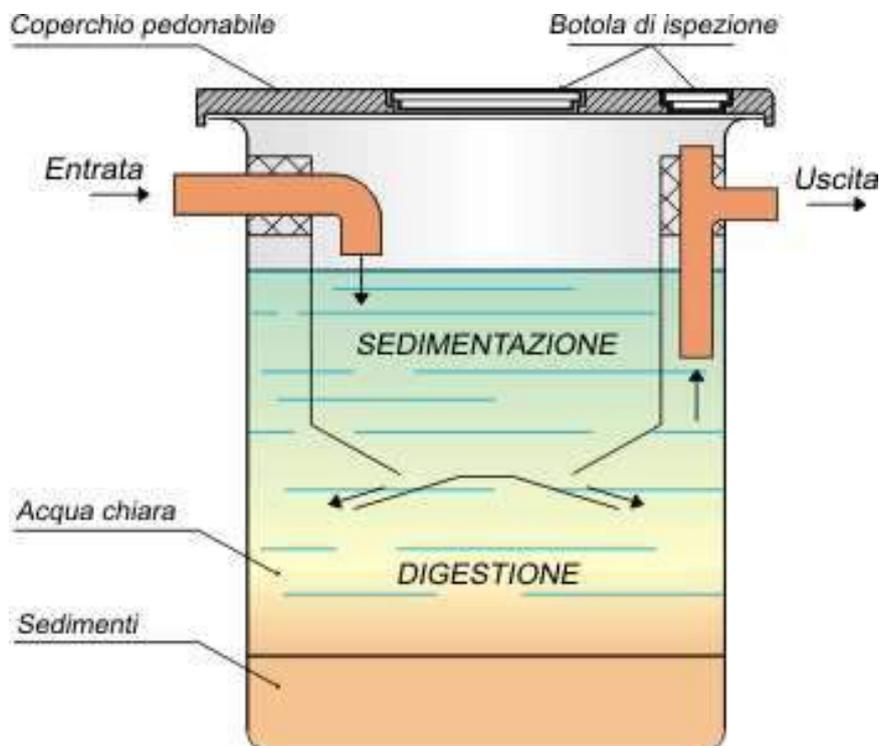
Vasca Imhoff a pianta rettangolare.
